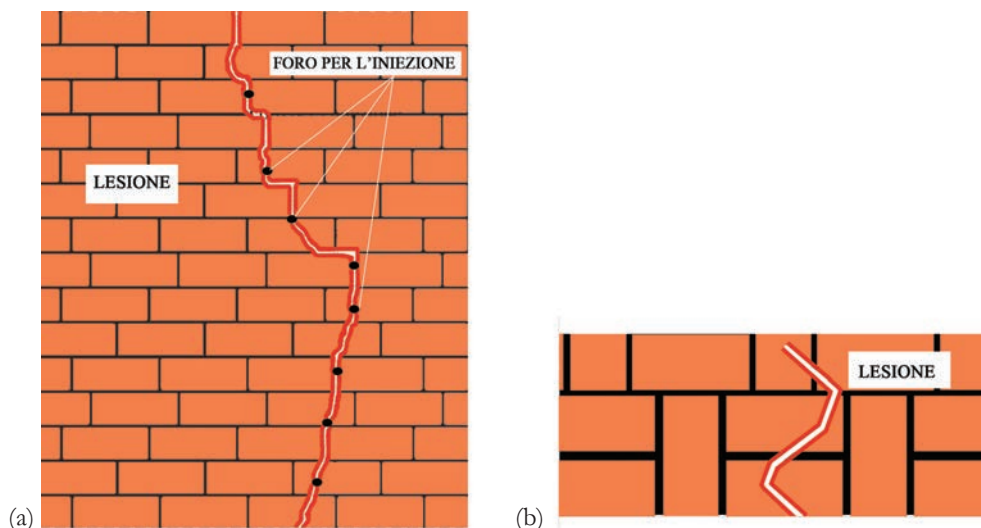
Iniezione della lesione: a) vista prospettica; b) vista in sezione trasversale.
